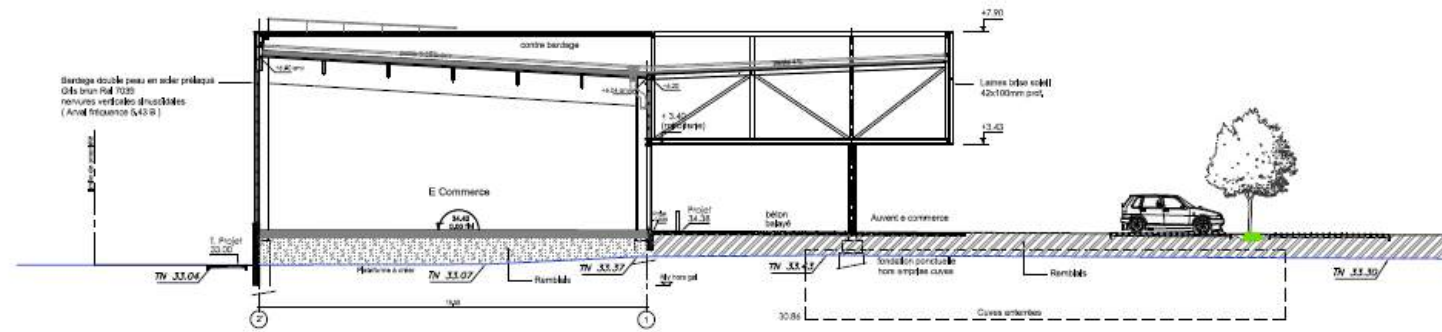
Coupe 4-4 des remblais (en bleu) sous le parking et le E-commerce
